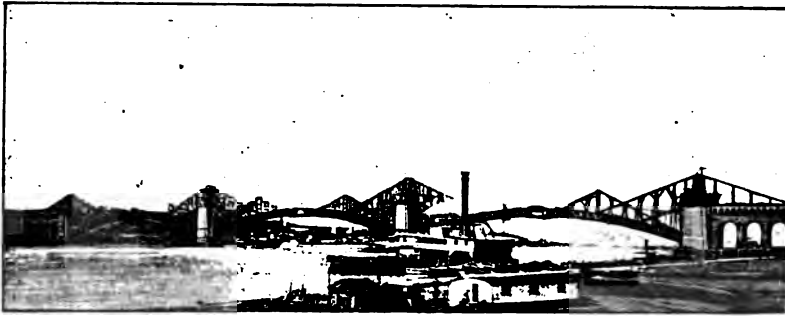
Pont de Saint-Louis (pendant le Montage).
